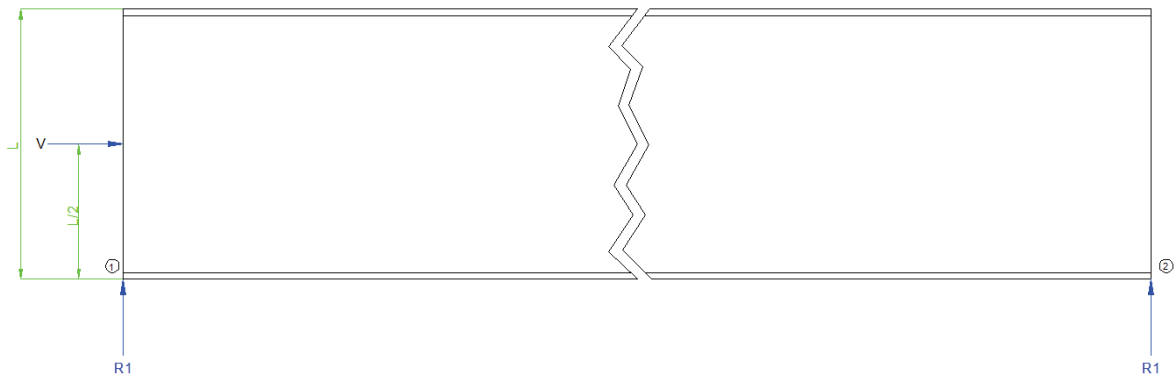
Carga de viento actuando longitudinalmente sobre la estructura
